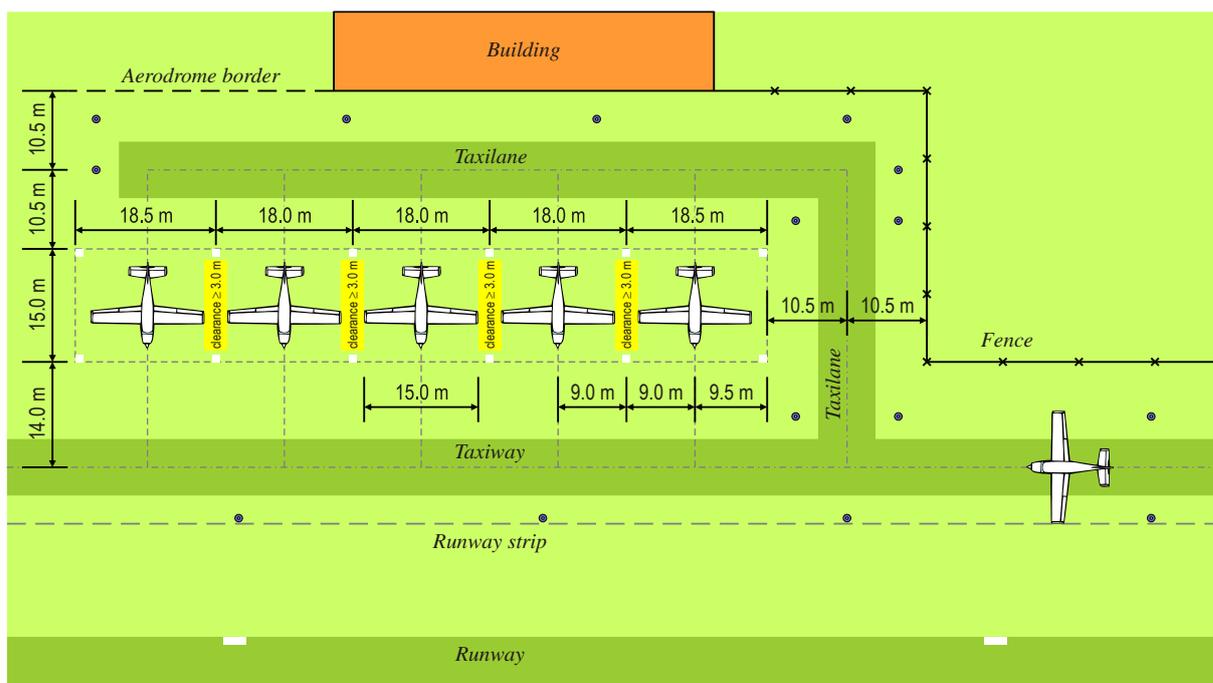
Delimitazione dall'area di traffico o dalla *run-up area* non pavimentate rispetto alla striscia di via di circolazione (rappresentazione schematica per un aeromobile di riferimento con apertura alare di 15 m)
